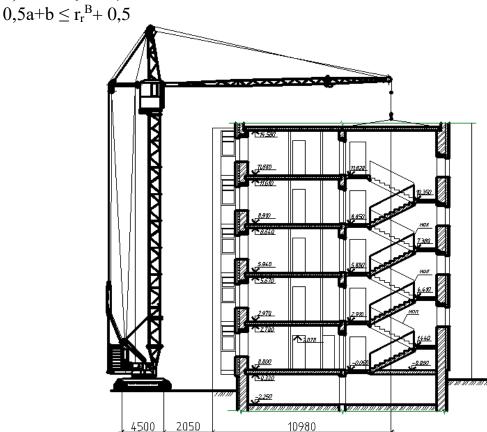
Монтаж плиты перекрытия краном КБ-100.1
